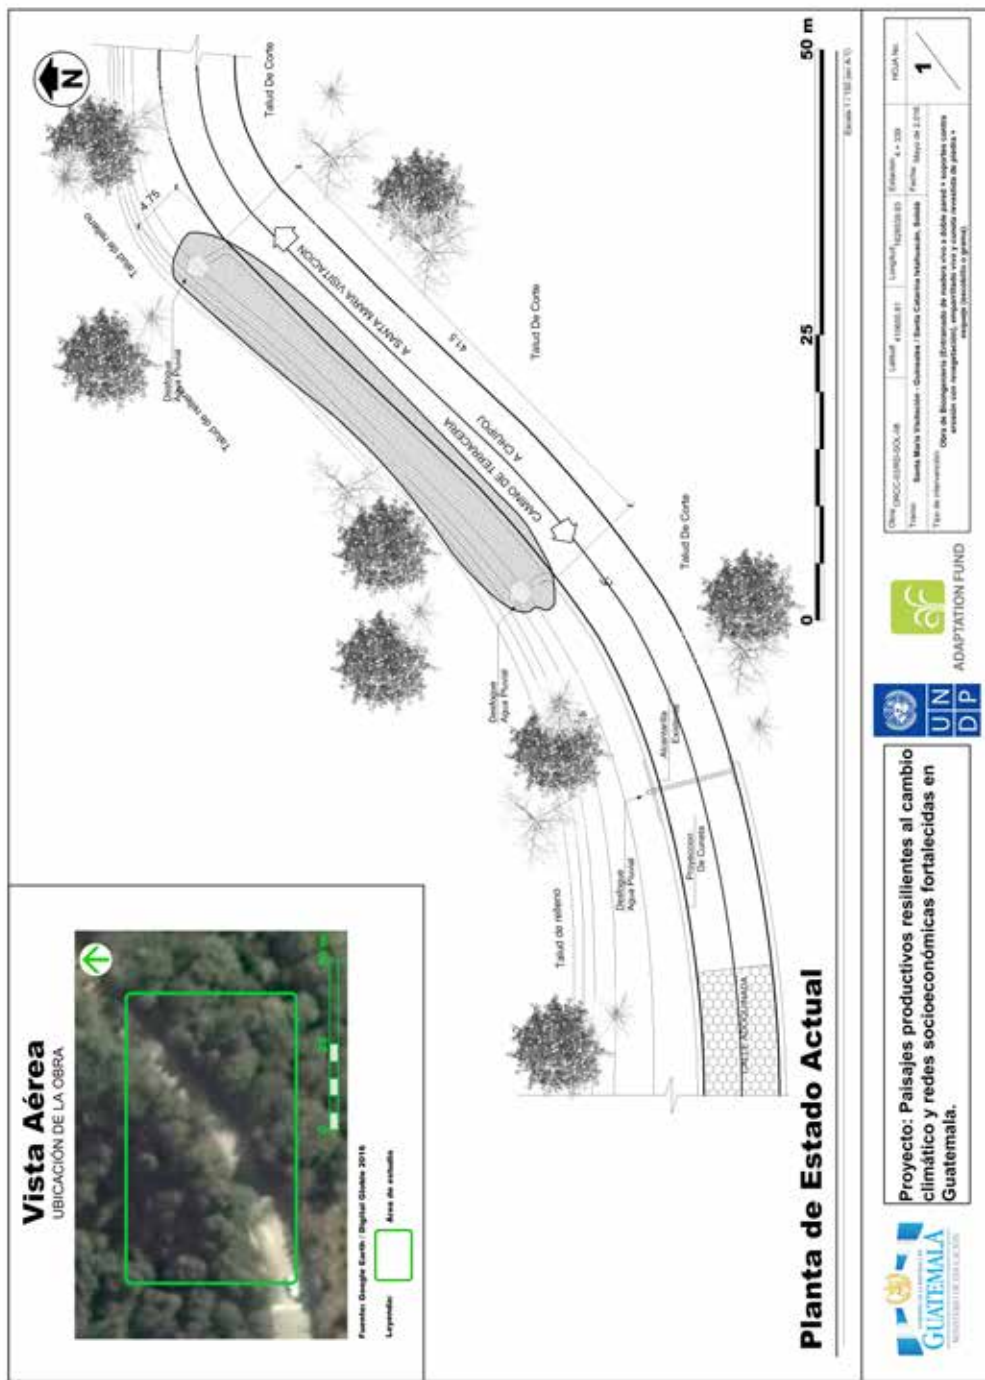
A. PLANTA ESTADO ACTUAL. Planificación Obra ORCC-01/RD-SOL-08. Tramo: Santa María Visitación-Guineales, Sta. Catarina Ixtahuacán.
